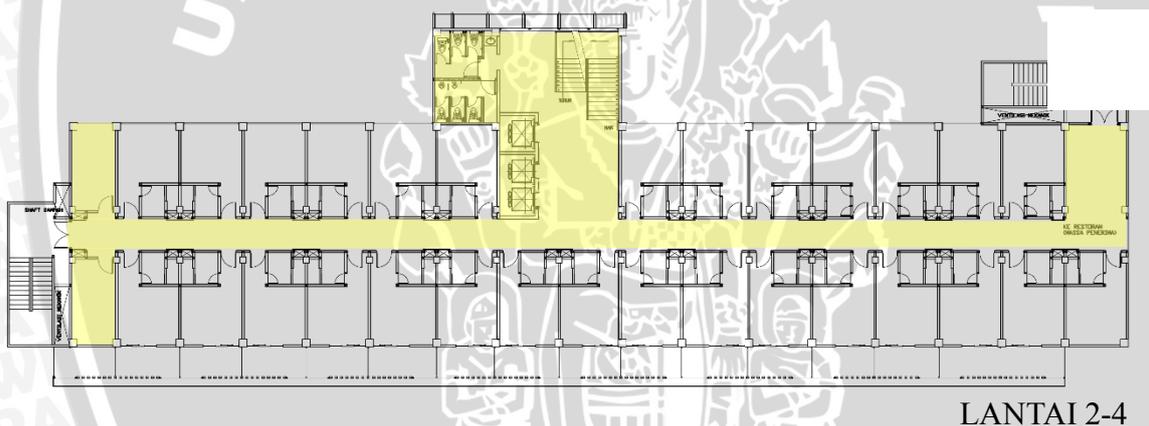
102 Denah lantai 2 massa penerima dan bisnis
